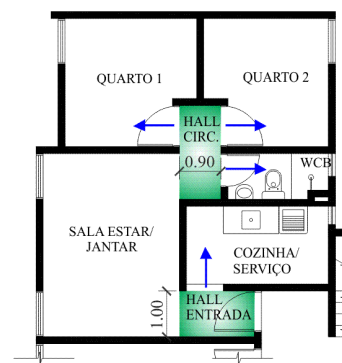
Planta Baixa Pav. Tipo: Hall de Circulação do Residencial Costa Dourada (sem escala)
